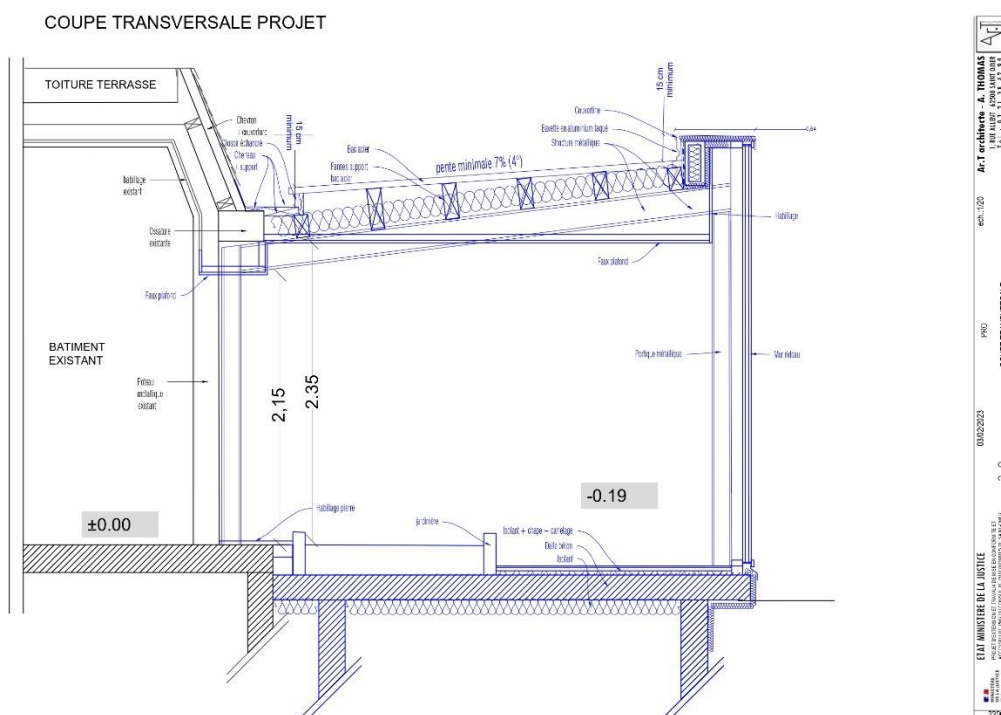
coupe transversale du projet (Source : Ar.t architecte)
